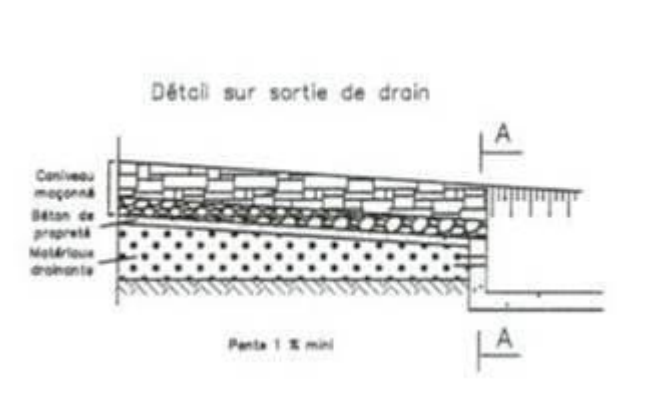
PROFIL EN TRAVERS DE DRAIN
